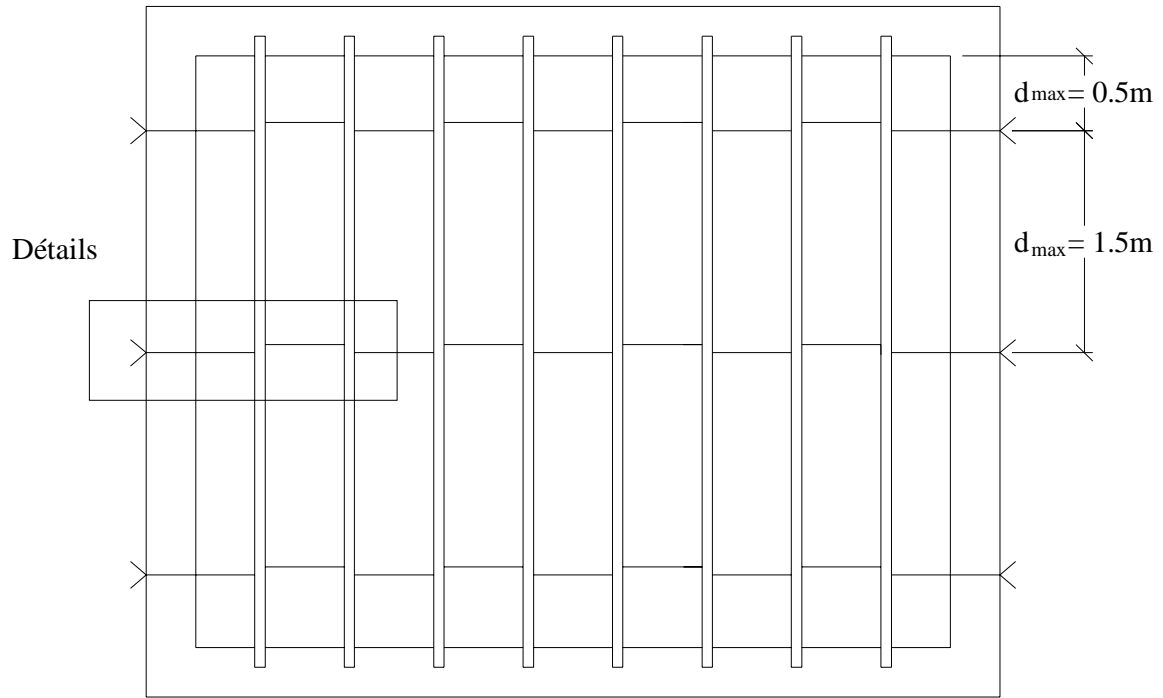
Liaison poutre de plancher bois-mur utilisant une lisse chevillée au mur
